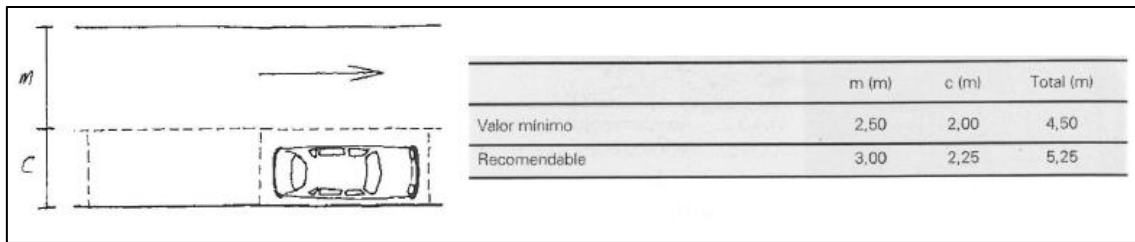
Anchura aparcamiento. Fuente: Apuntes Urbanismo Grado Ingeniería Civil (UPC).
